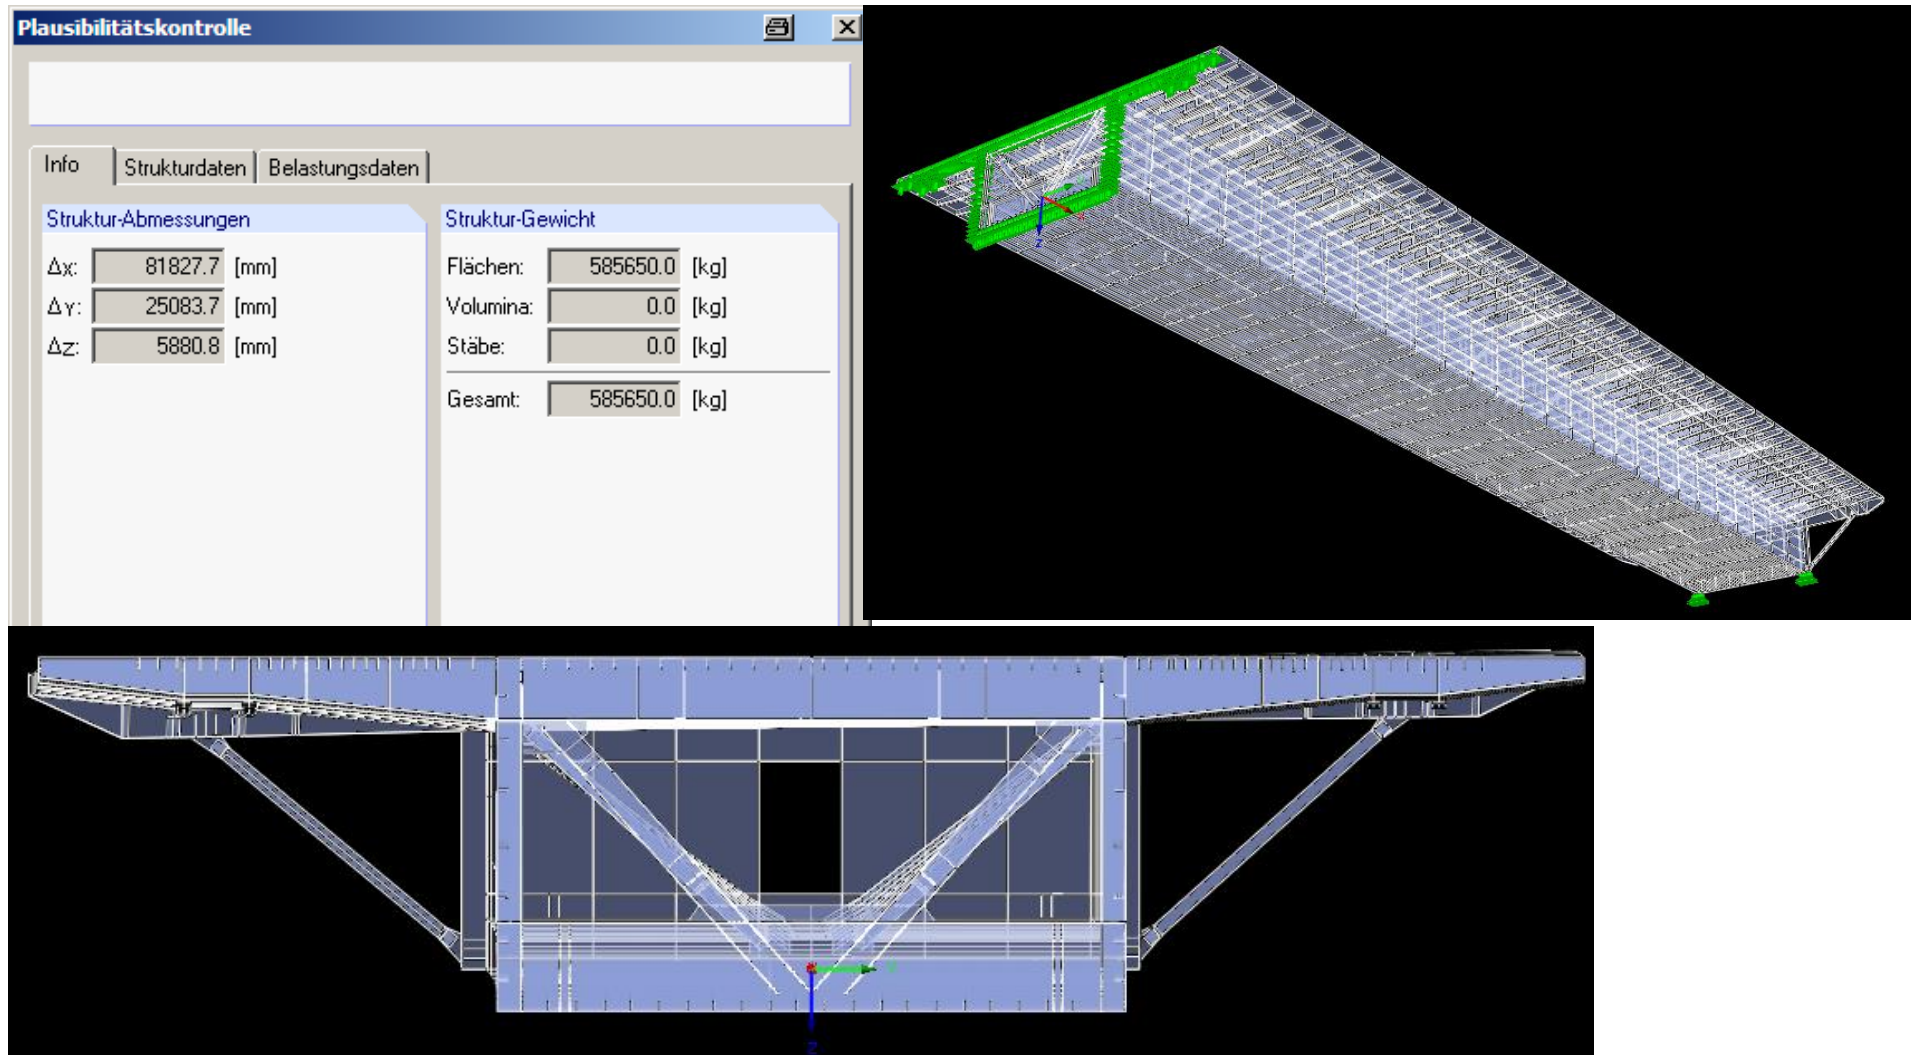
Finite Elemente Modellierung – Randfeld Schönberg und Plausibilitätskontrolle der eingegebenen Brückengeometrie und Massenbelegung
